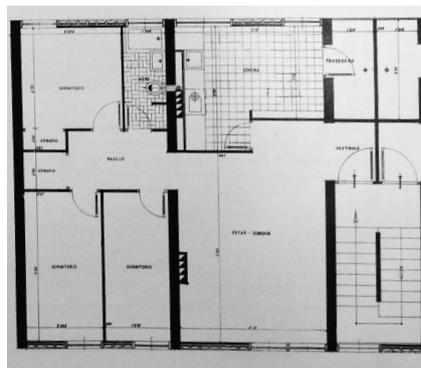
Romany. Concurso de Vivienda Experimental. Planta tipo de la vivienda colectiva en el bloque de cuatro plantas. Madrid, 1956.
